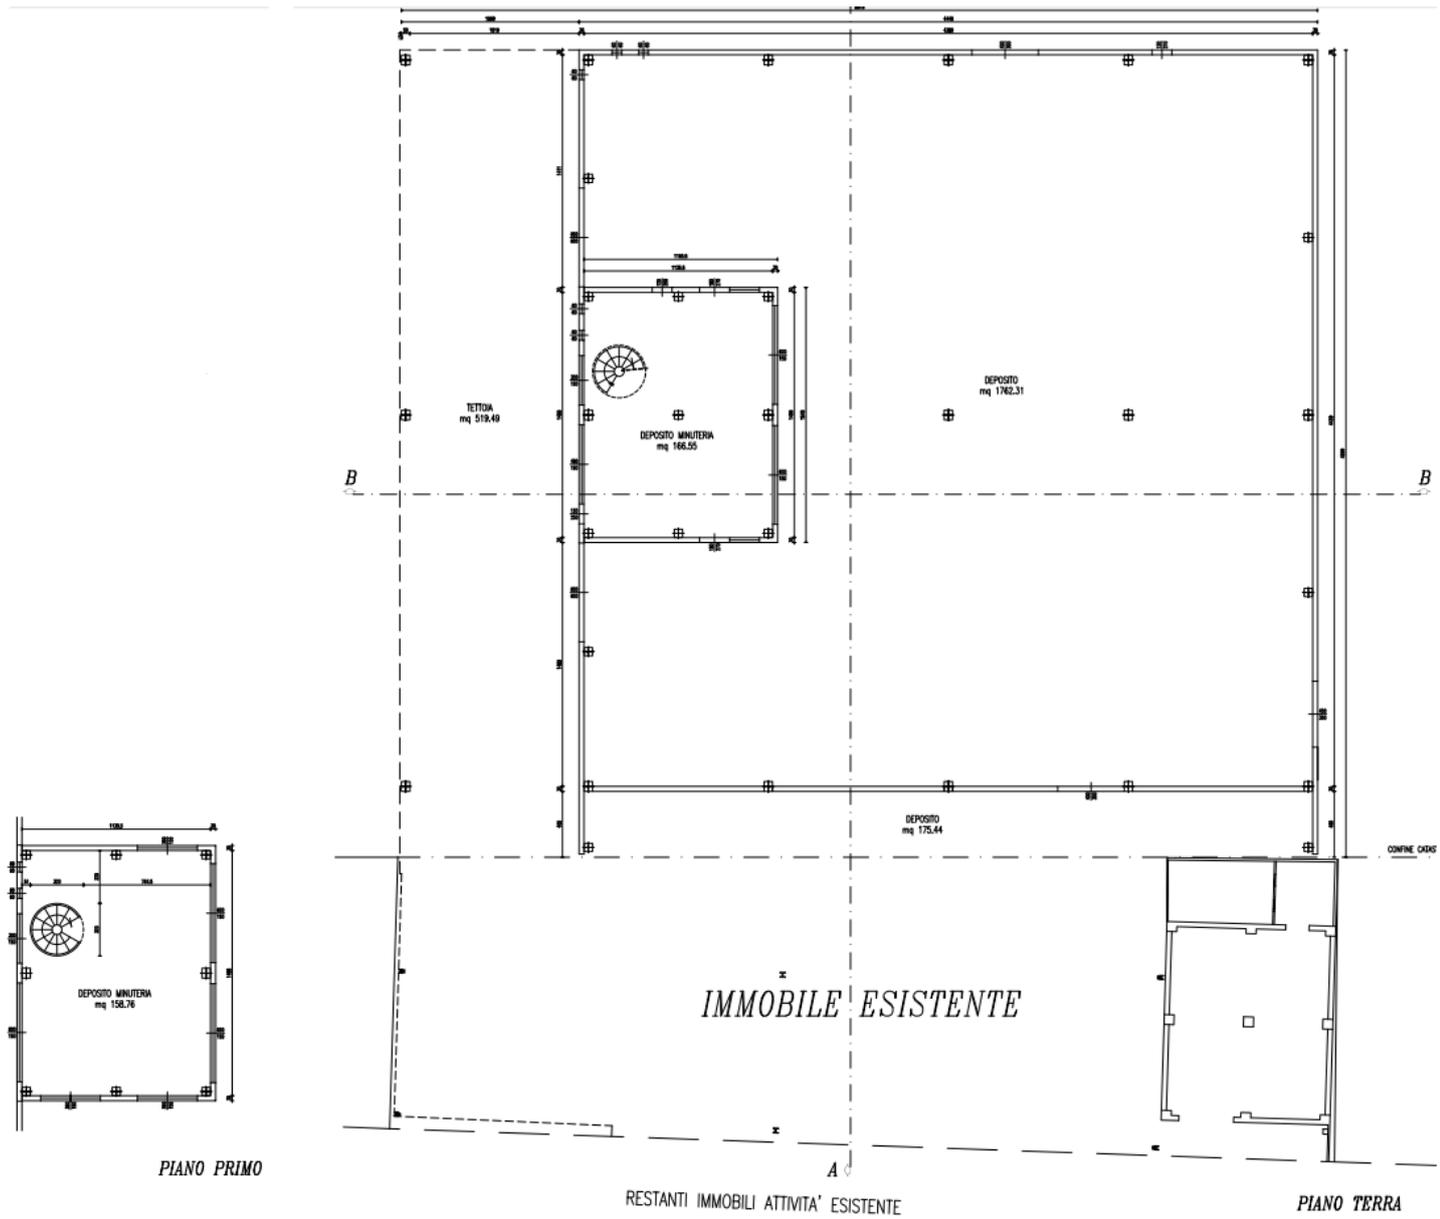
Estratto Tav. 4 – Piante, sezioni, prospetti - stato legittimo
